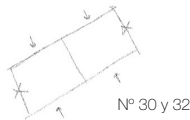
Bocetos en planta de la disposición de las construcciones situadas en la Rúa Moaña-Coia, nº 30 y 32 (autoría propia)
